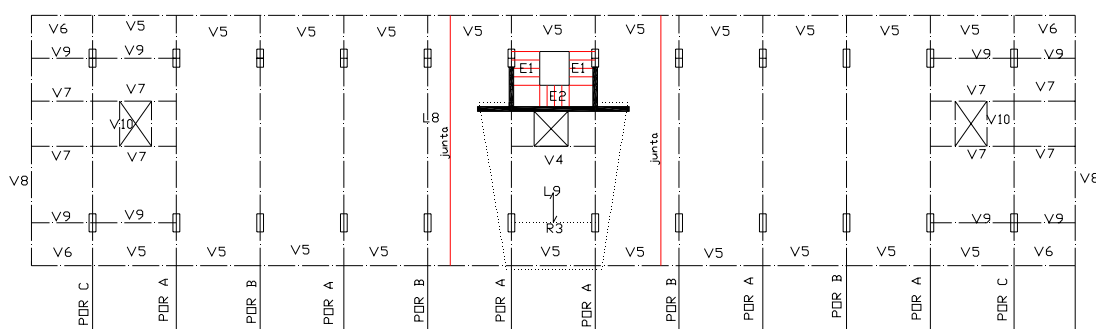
Planta estrutural do piso de entradas (R/C)
